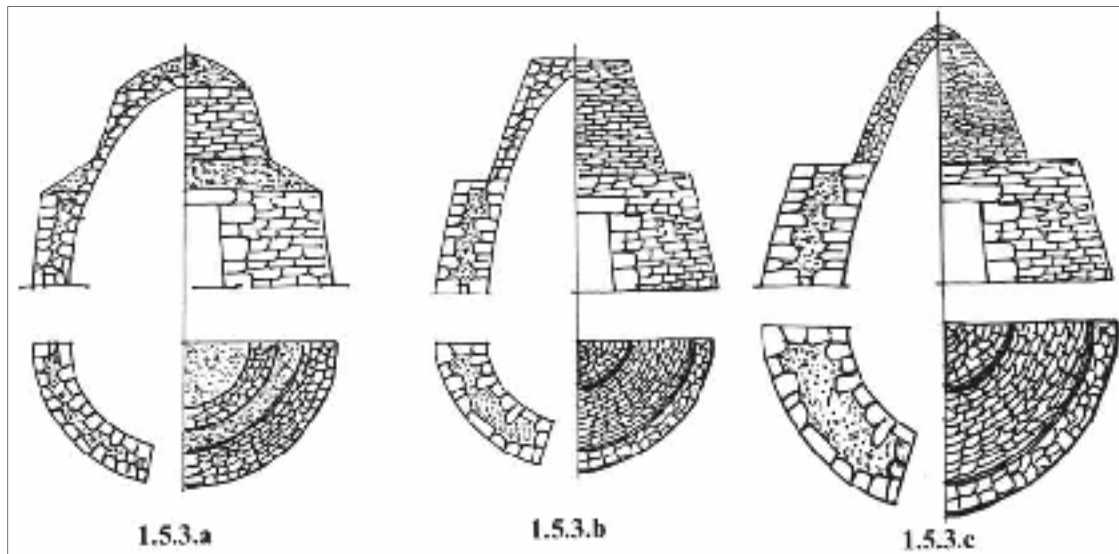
Construcciones de perfil escalonado simple y elementos superpuestos.
